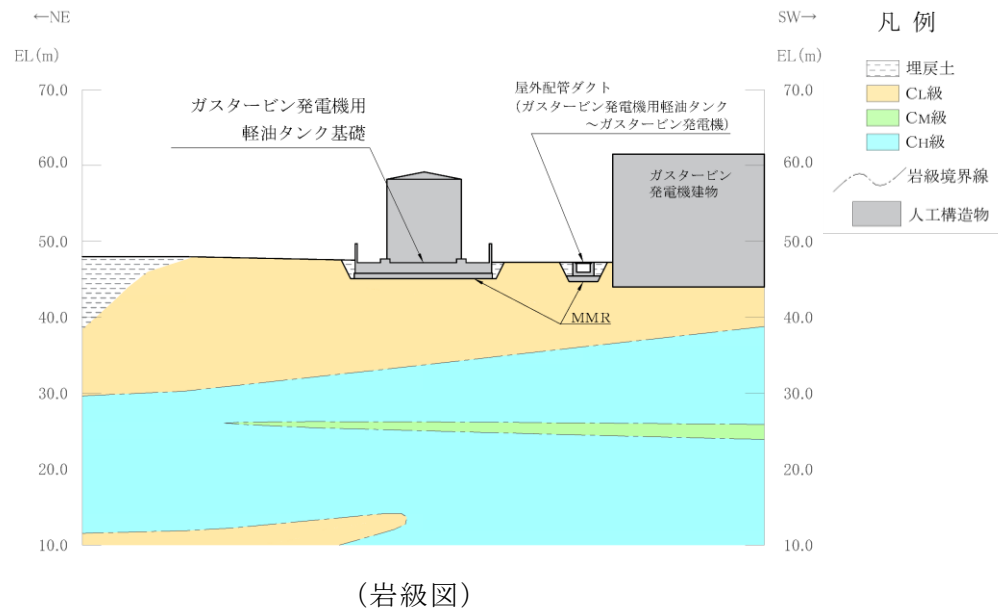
ガスタービン発電機用軽油タンク基礎 地質断面図 (B-B断面)
